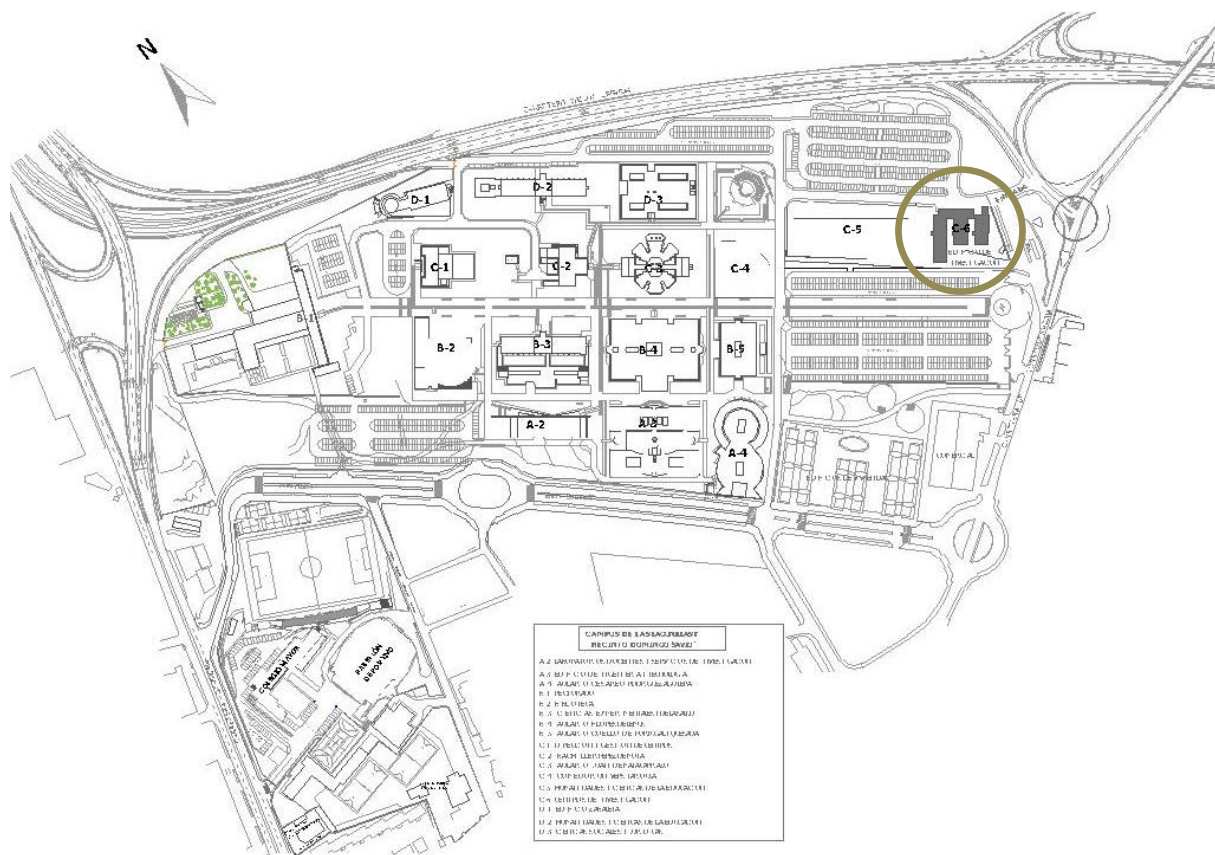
Plano de situación del edificio. Fuente: Proyecto técnico de ejecución.
